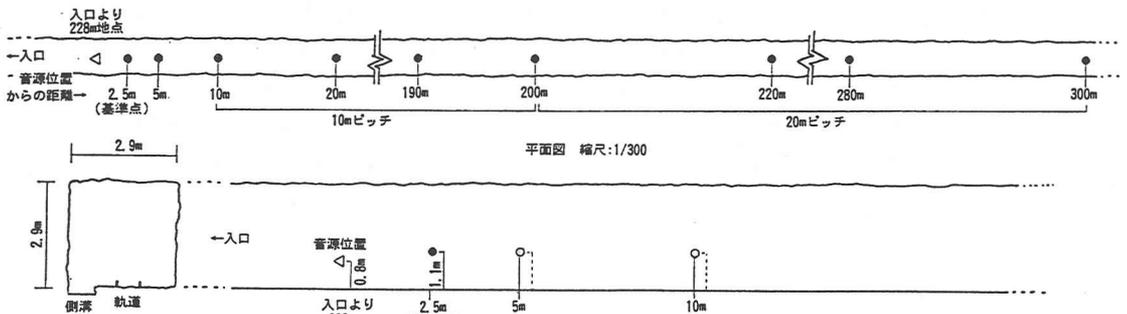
住友金属鉱山 佐々連鉱山坑道平面・断面図
